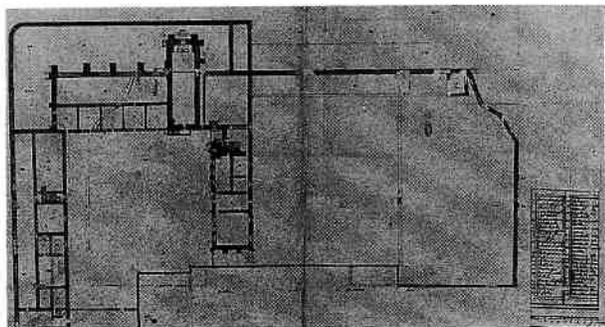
PLAN DU PALAIS VERS 1671, DIT PLAN DES ORATORIENS (Arch. nat., N III, Seine-et-Marne 461-3)
